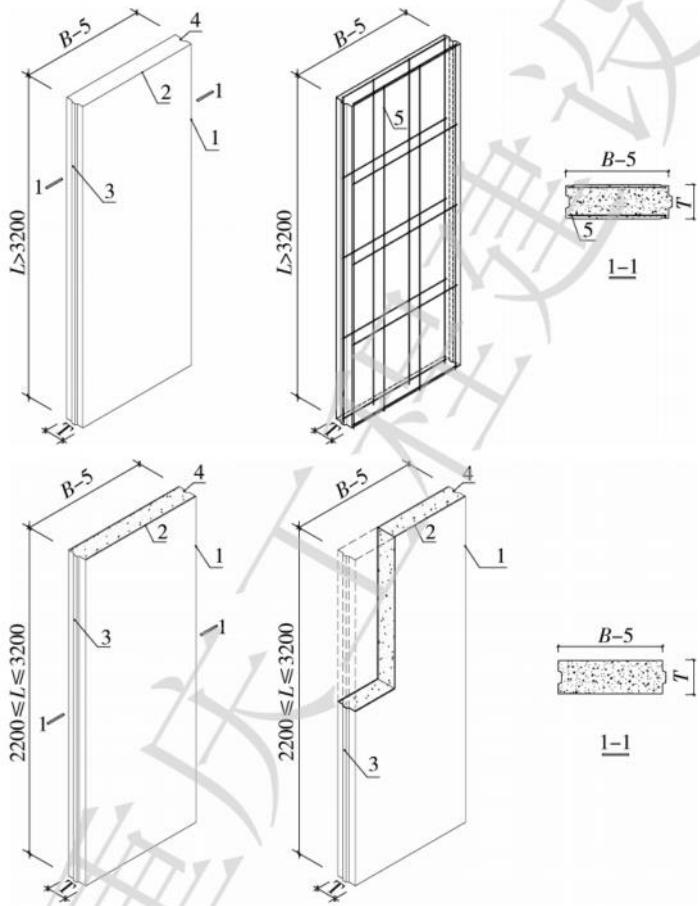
增强型发泡混凝土轻质条板构造示意图
